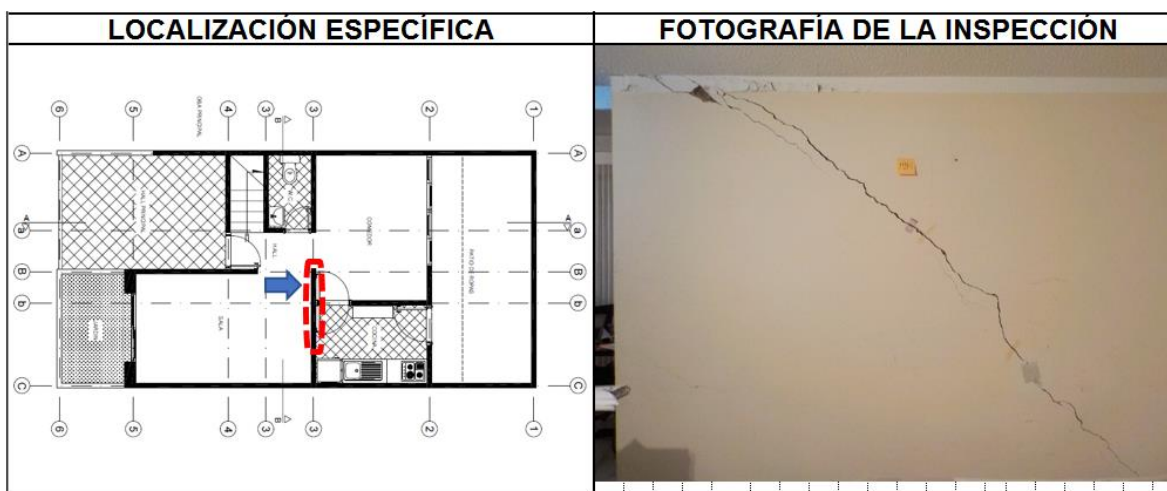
Lesiones del muro M14 del primer piso, se observa una grieta en diagonal. Fuente propia 2017.
